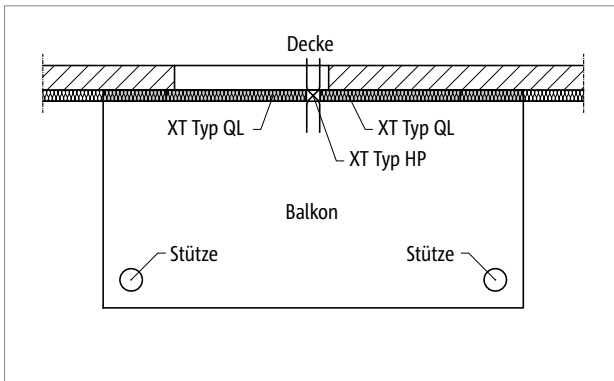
Schöck Isokorb® XT Typ QL: Balkon mit Stützenlagerung
